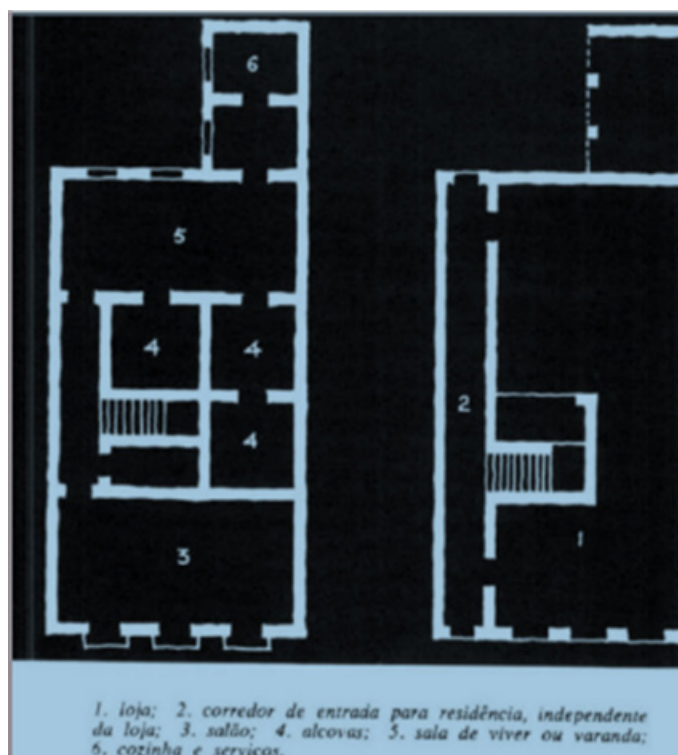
Configuração do padrão da planta baixa das casas coloniais. Fonte CAVALCANTTI, 2018, p.18
